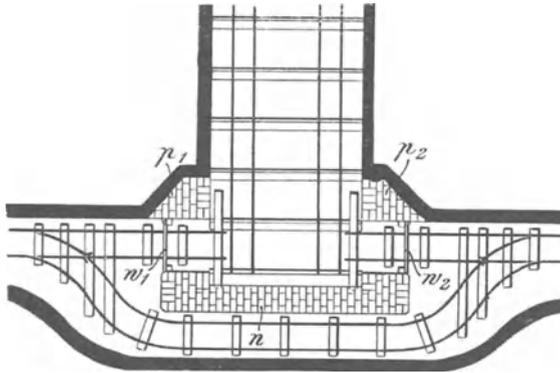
<sup>1)</sup>. Anschlag mit Schutzmauer bei flacher Lagerung (Grundriß).
